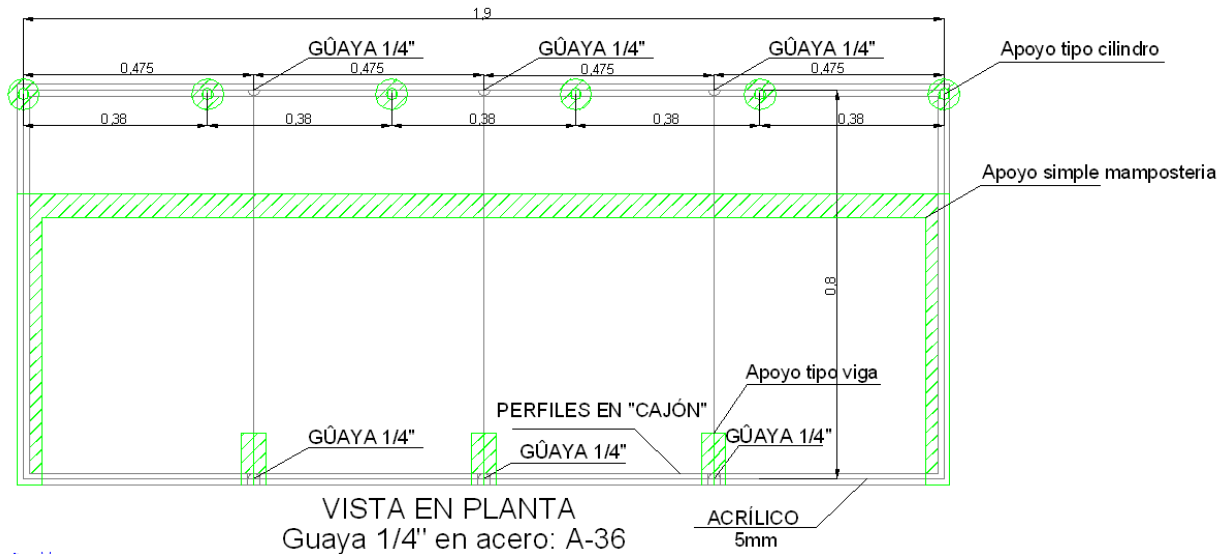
8 Vista en planta de la localización de los apoyos del modelo.
